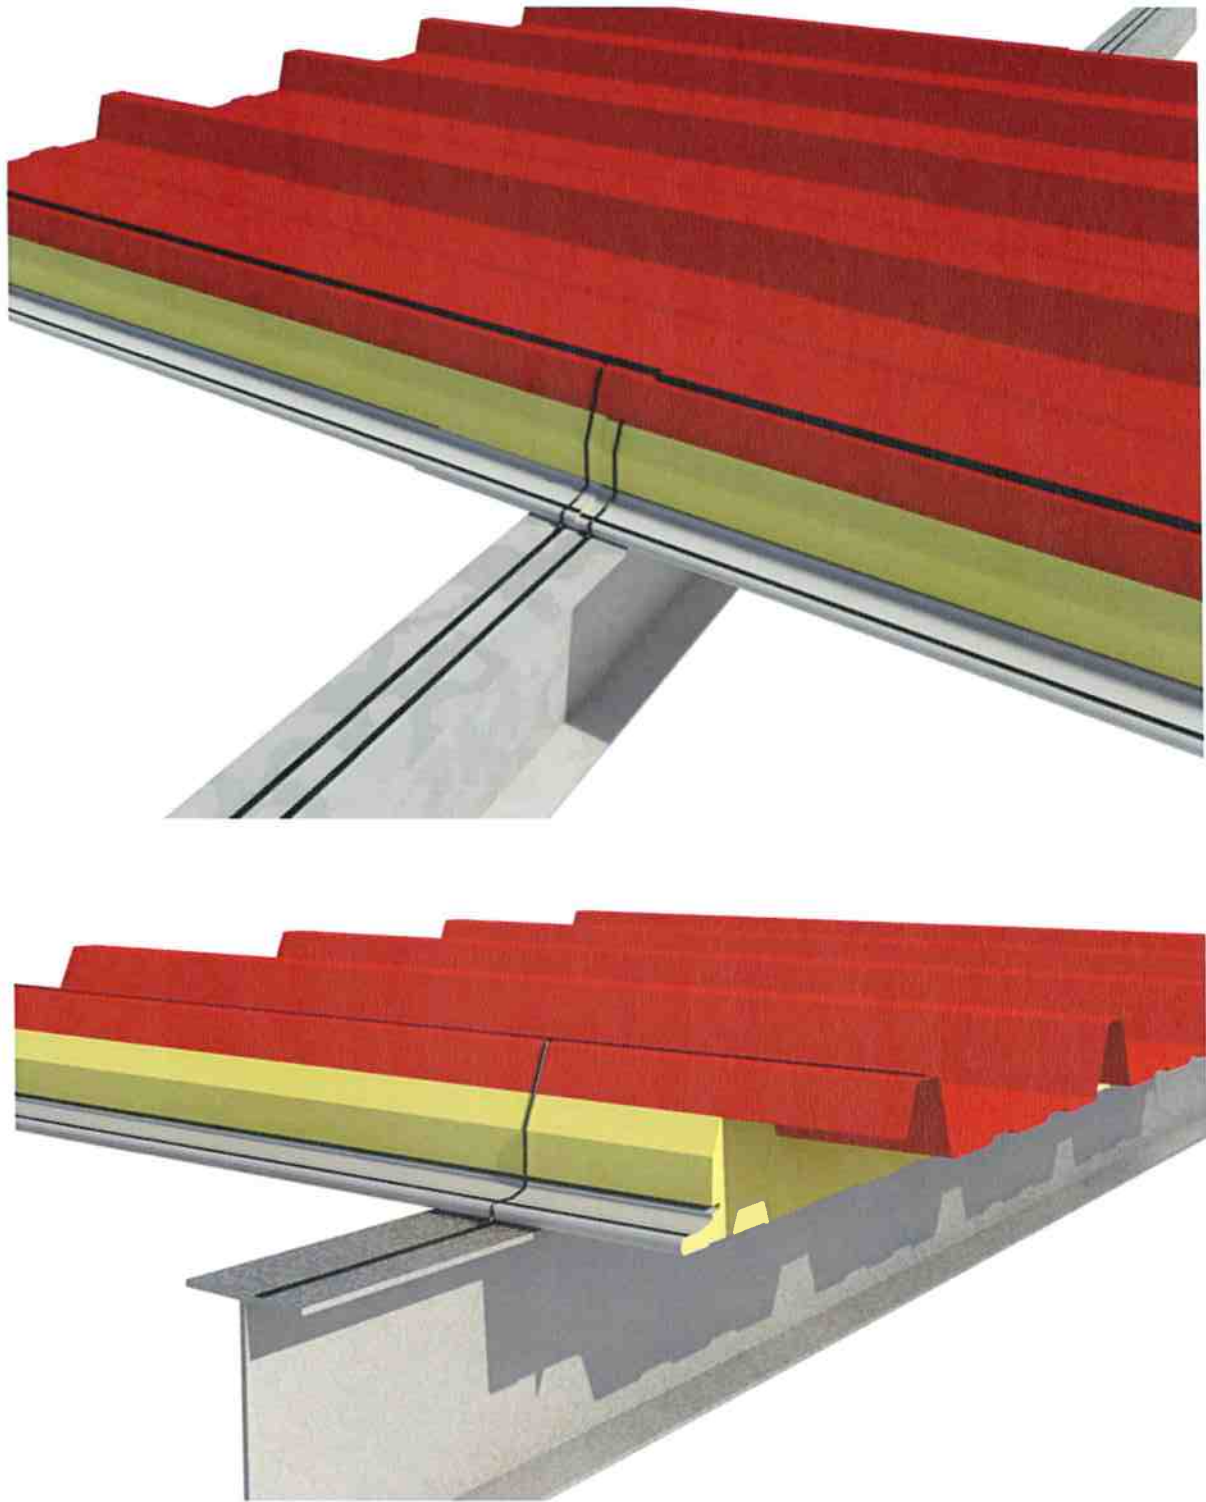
Complément d'étanchéité (CE) transversal et longitudinal au droit d'un recouvrement transversal
